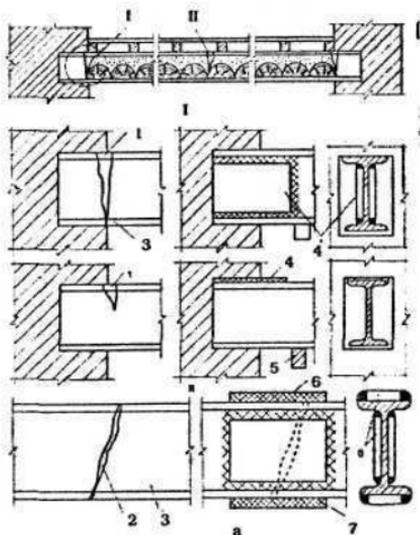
Ремонт деревянных перекрытий по металлическим балкам:
